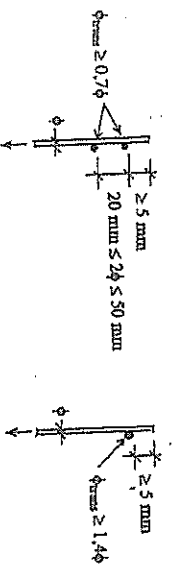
Ancoragem de estribos através de barras transversais soldadas
